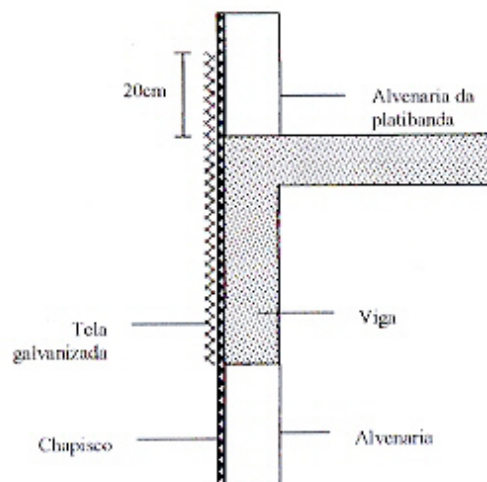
Telamento de encontro alvenaria de platibanda com estrutura – seção transversal (CARVALHO JR., 2005).
